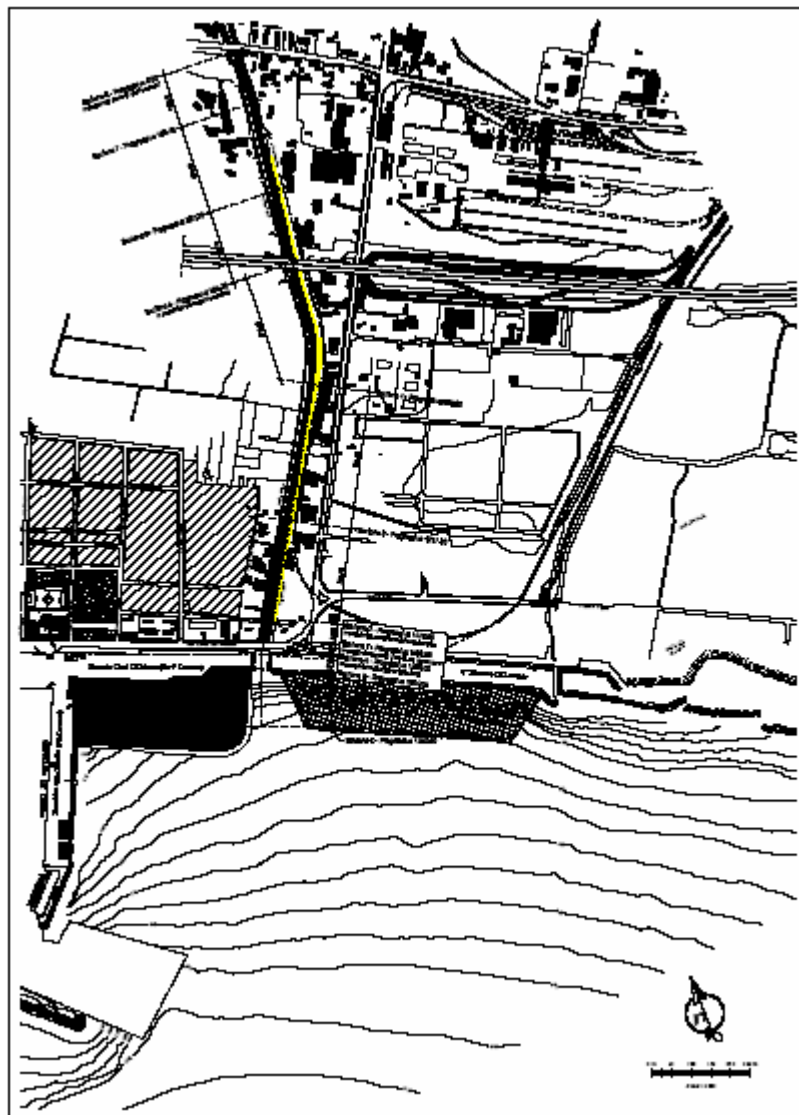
Planimetria del tratto terminale del Torrente Carrione
